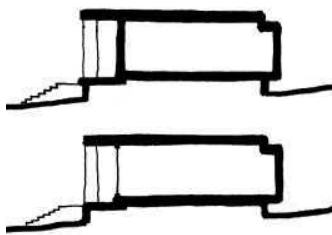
Sección casa no lugar de paço. Vista cerra y vista abierta al paisaje
